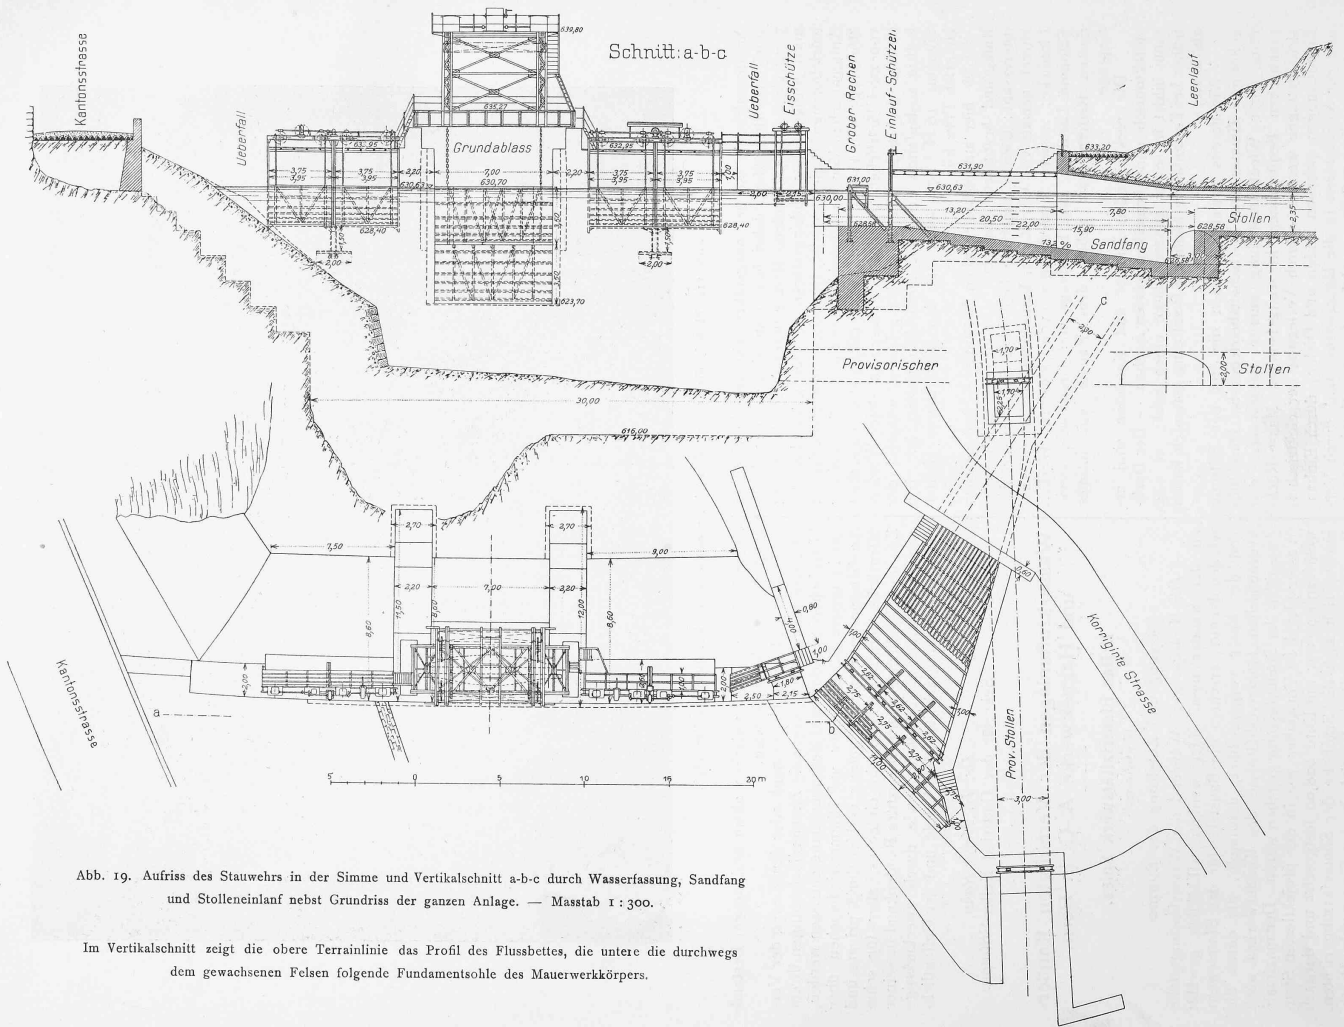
Aufriss des Stauwehrs in der Simme und Vertikalschnitt a-b-c durch Wasserefassung, Sandfang und Stolleneinlauf nebst Grundriss der ganzen Anlage. — Masstab 1:300.
